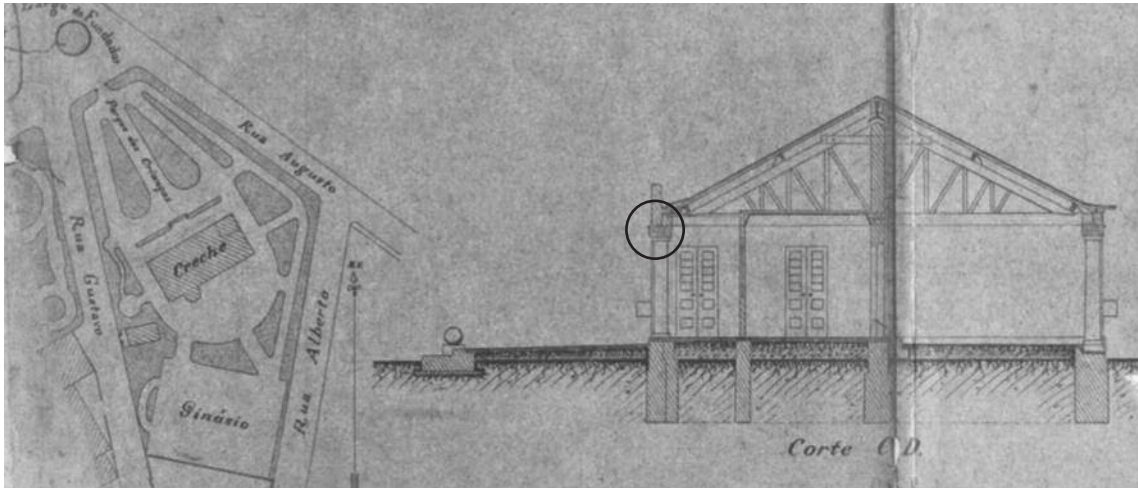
Planta de implantação e Corte transversal do projecto da Creche.
